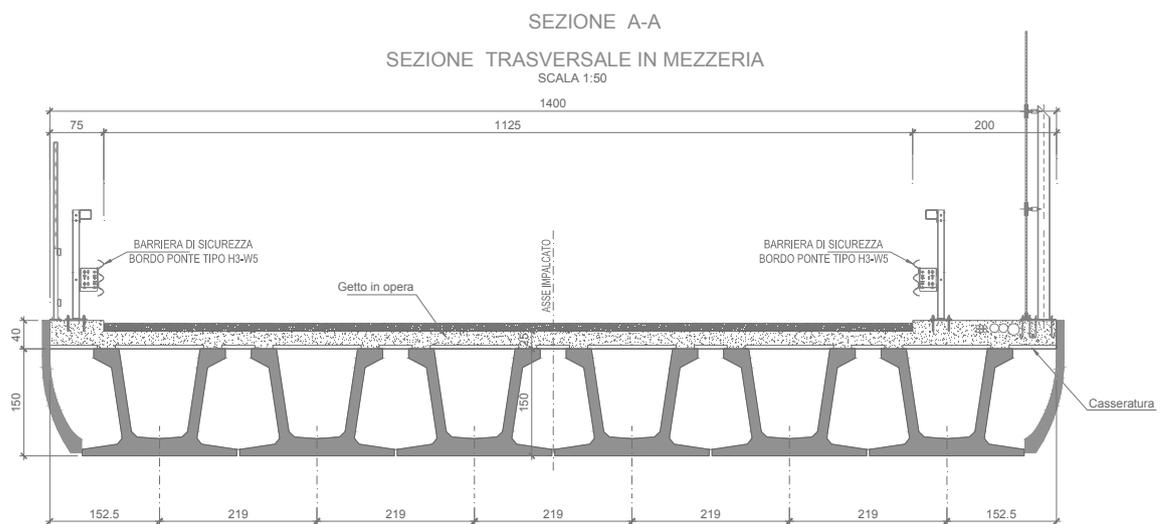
Sezione trasversale Viadotto Mason Pianezze asse Sud
